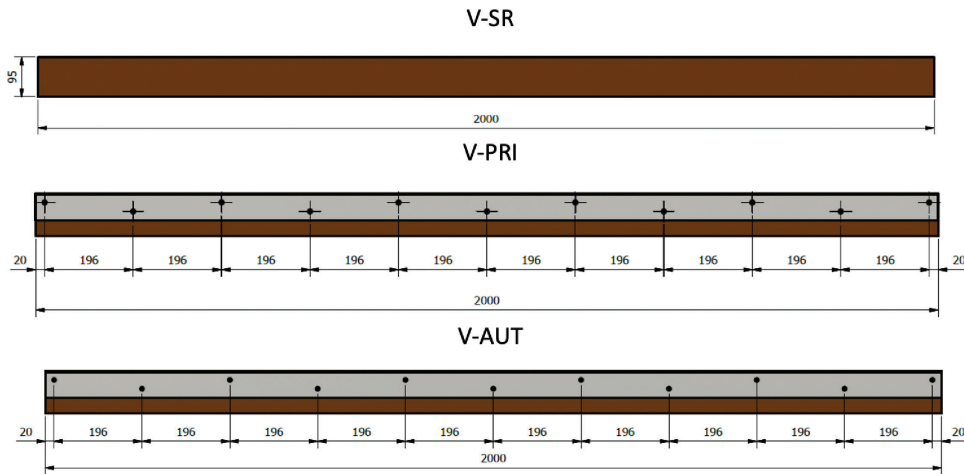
Configuração da face lateral das amostras analisadas (dimensões em mm).
